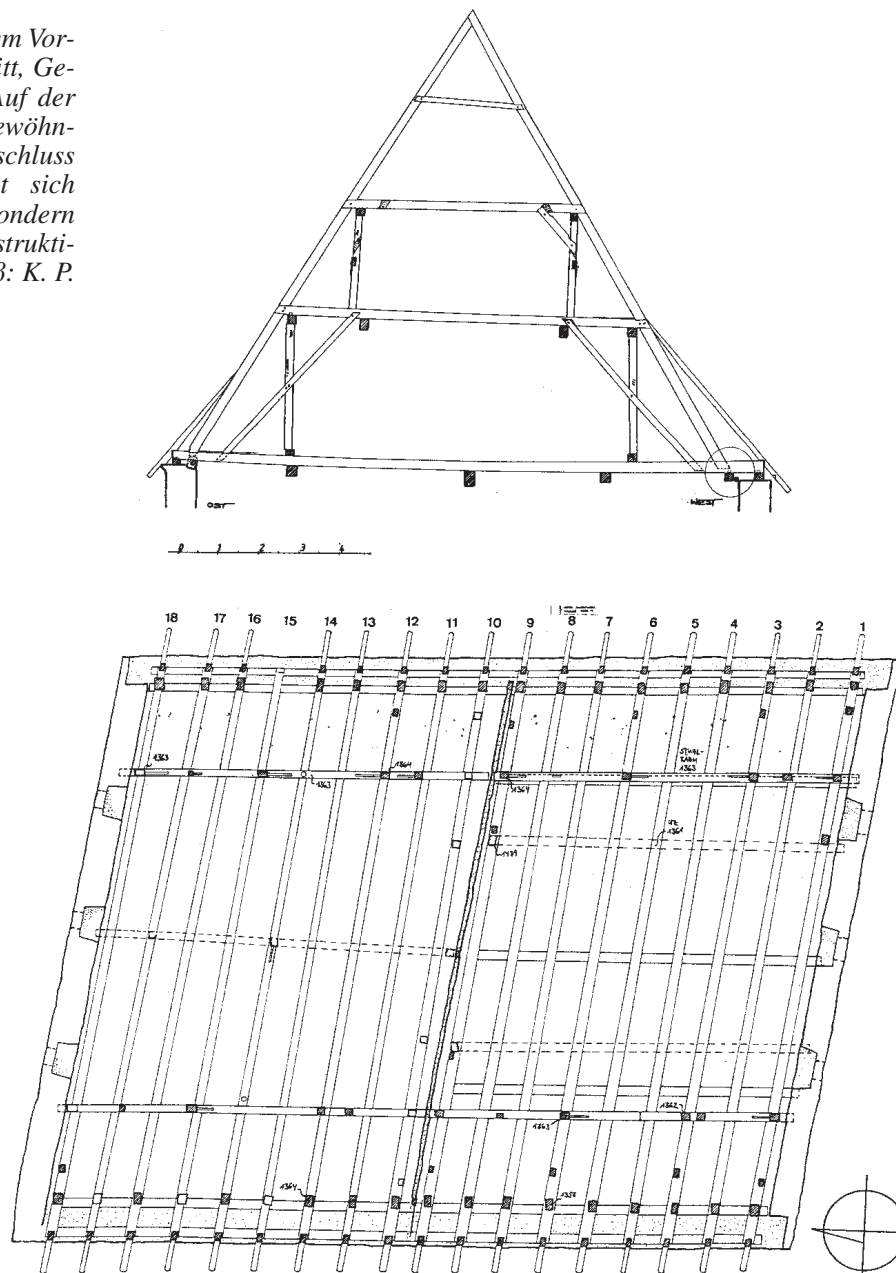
Nördlicher Hinterflügel, Querschnitt durch die Dachkonstruktion (Gesp. 9). Die aus 18 Gespärren bestehende Dachkonstruktion wurde im ersten Dachgeschoss mit doppelt stehendem Stuhl ausgestattet. Besonders interessant sind hier die Riegel, die im Querverband zwischen die Stühle für die Auflage eines Mittelunterzuges gezapft wurden. Sie beantworten teilweise die Frage einer eventuellen Dachnutzung: Das Bedürfnis, das Gefüge durch einen Unterzug zu stärken, aber gleichzeitig die Dachmitte frei zu halten, weist auf eine Lagernutzung hin. Dafür spricht auch eine Aufzugsluke über dem hinteren (östlichen), befahrbaren Gebäudeabschnitt, die über alle Geschosse führt (Aufmaß: K. P. Wittwar).
